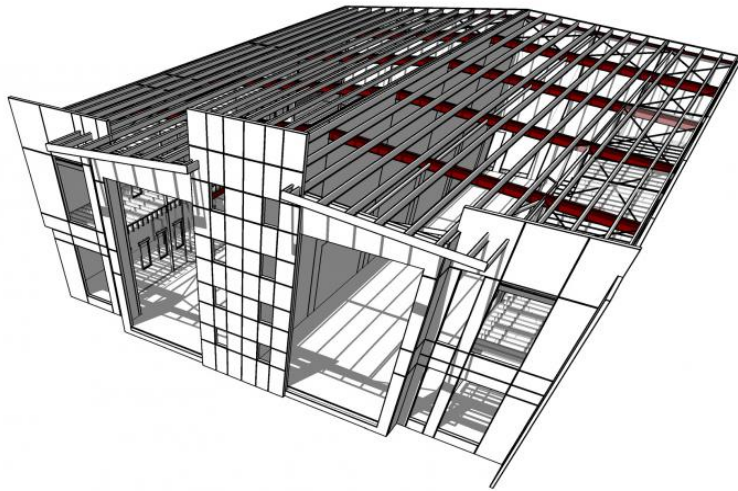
Exemplo de um modelo realizado em Revit Estrutural
